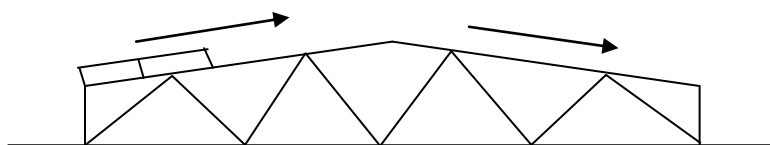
Порядок монтажа плит в бесфонарных зданиях
